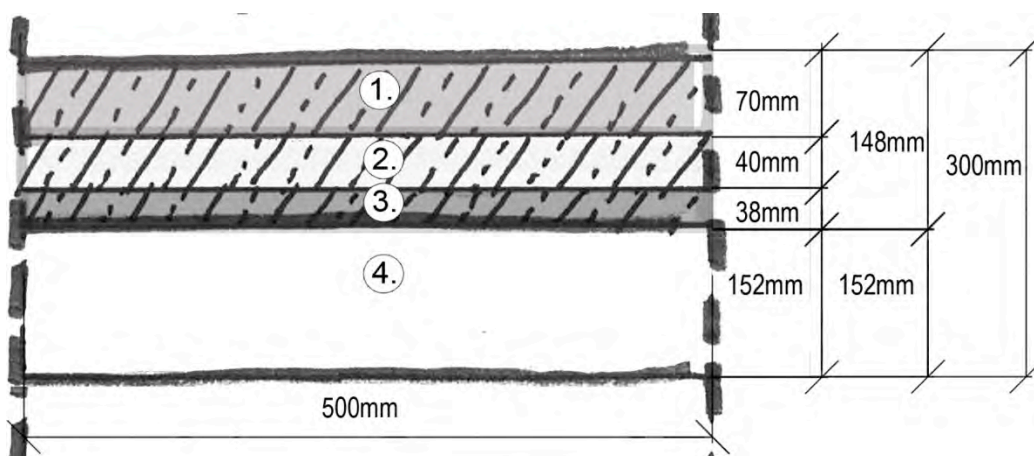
Durchschnittliche Betonmenge, = 148mm Beton Bestand, die kann als Vorlage gestellt werden, Hohlraumdecke Bestand_30cm_7cm
